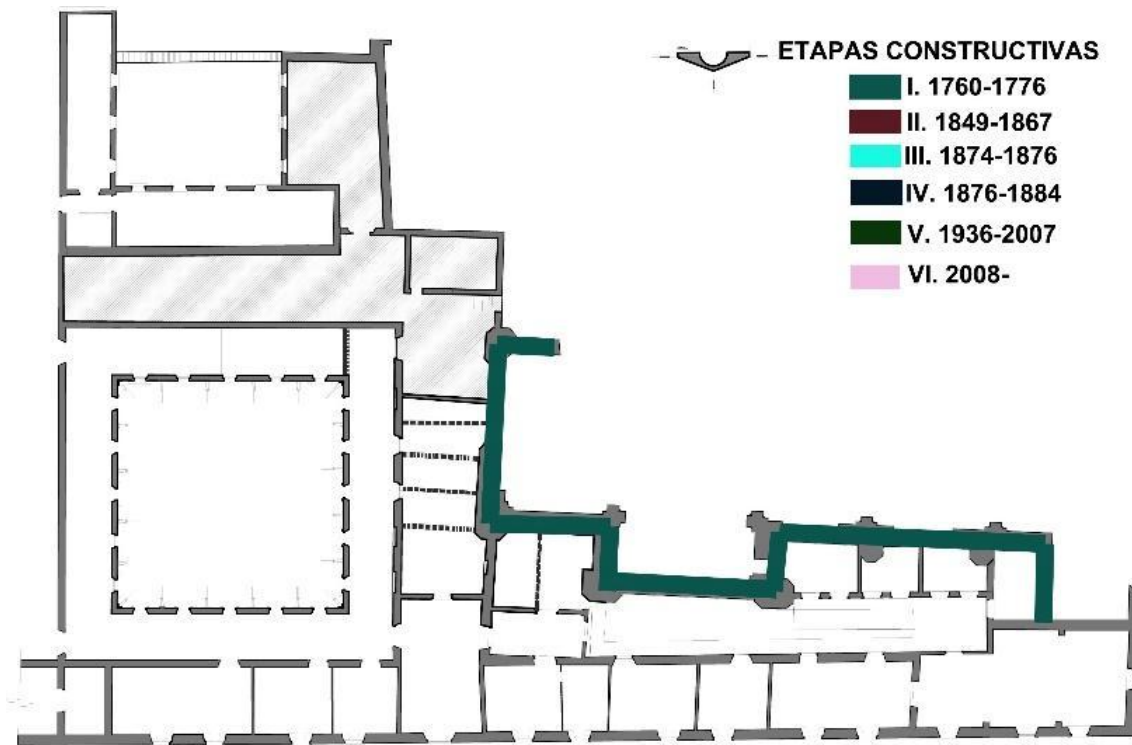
Primera etapa de construcción (Planta alta)¹²⁸
